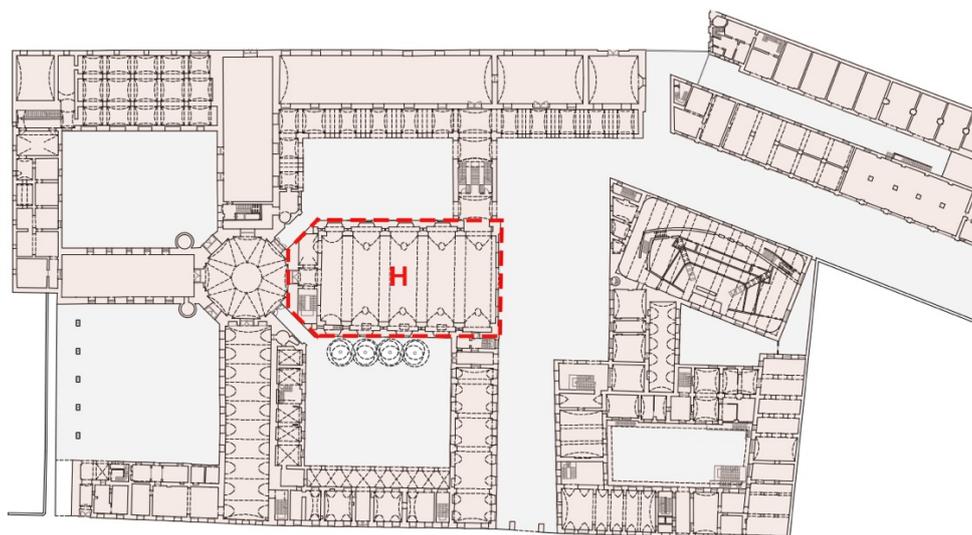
planimetria con evidenza edificio H- elaborazione personale
